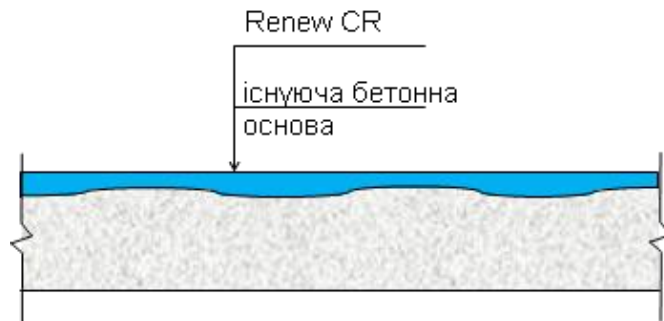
Стандартна схема відновлення бетонного покриття відкритих складів, рамп, бетонних сходів та пандусів
